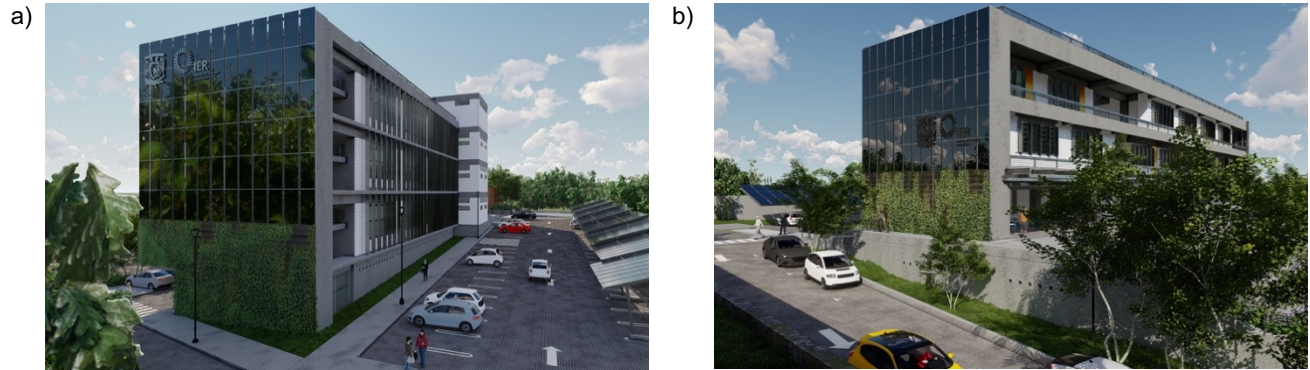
Protecciones solares tipo pantalla en fachadas a) este y b) oeste.
